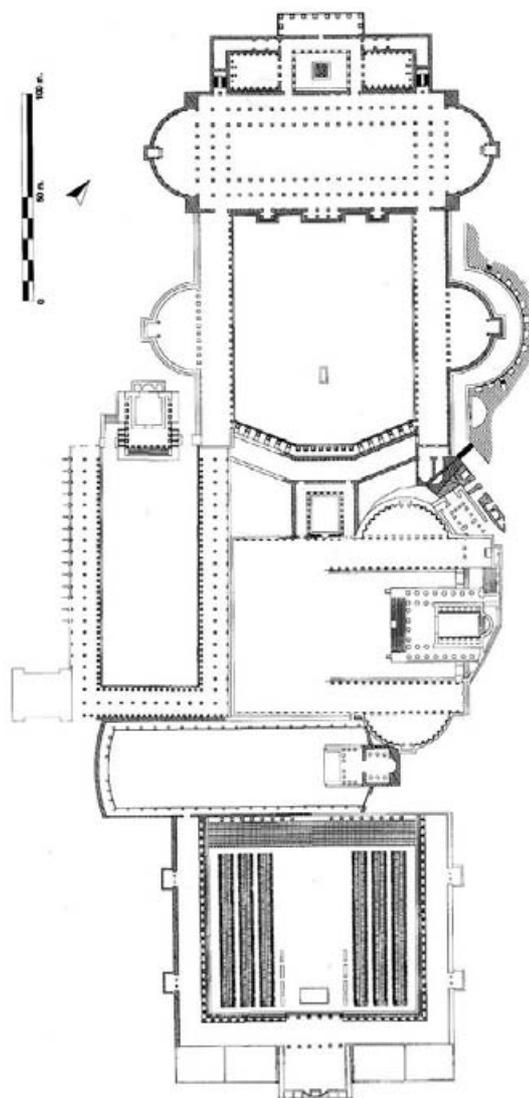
Planta reconstructiva de los foros imperiales de Roma (según S. Baiani y M. Ghilardi)
